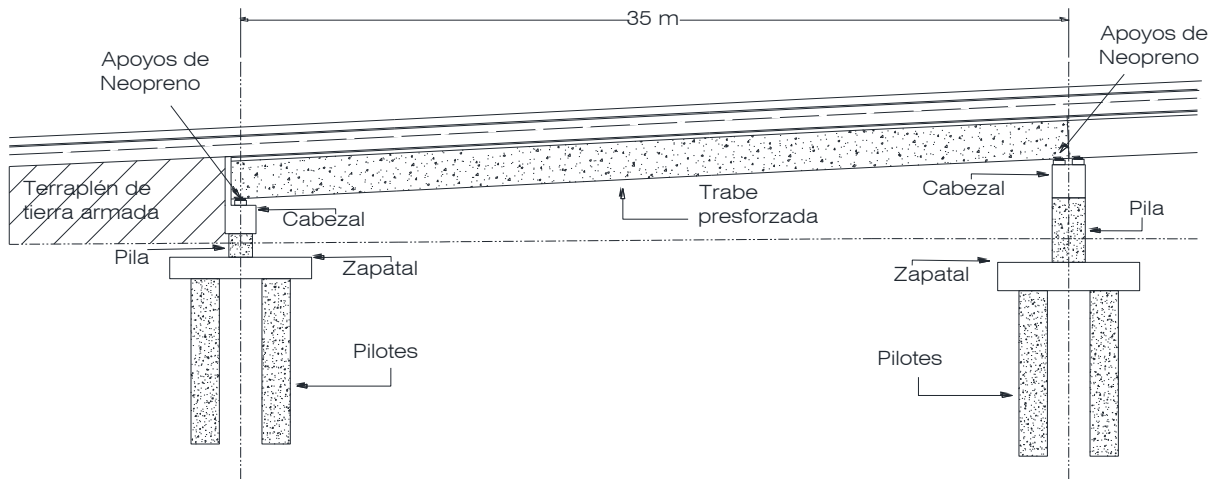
a Perfil del claro extremo del puente donde se llevaron a cabo las pruebas
